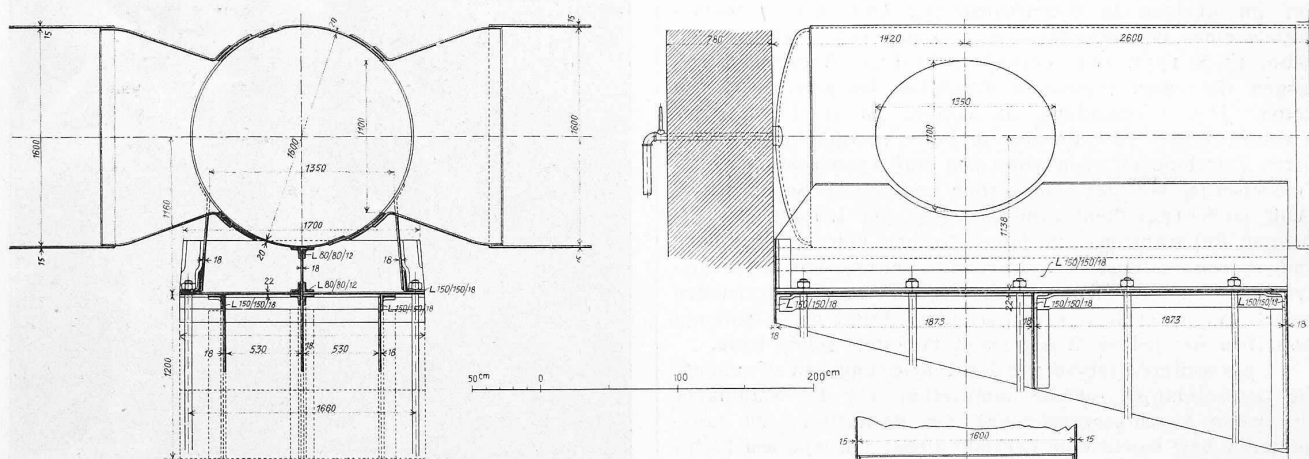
Das T-Stück der Druckleitung beim Maschinenhaus. — 1:40.
